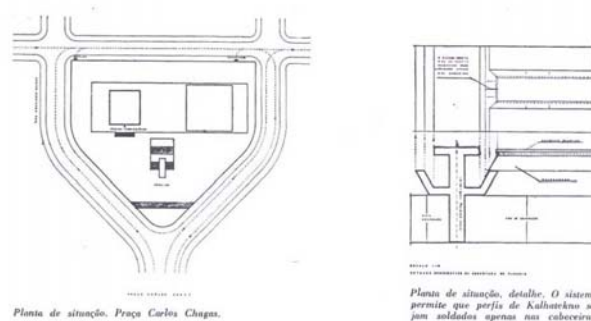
Plantas de situação e detalhe construtivo - Fonte: HABITAT, nº 70, dez., 1962, p. 5.
